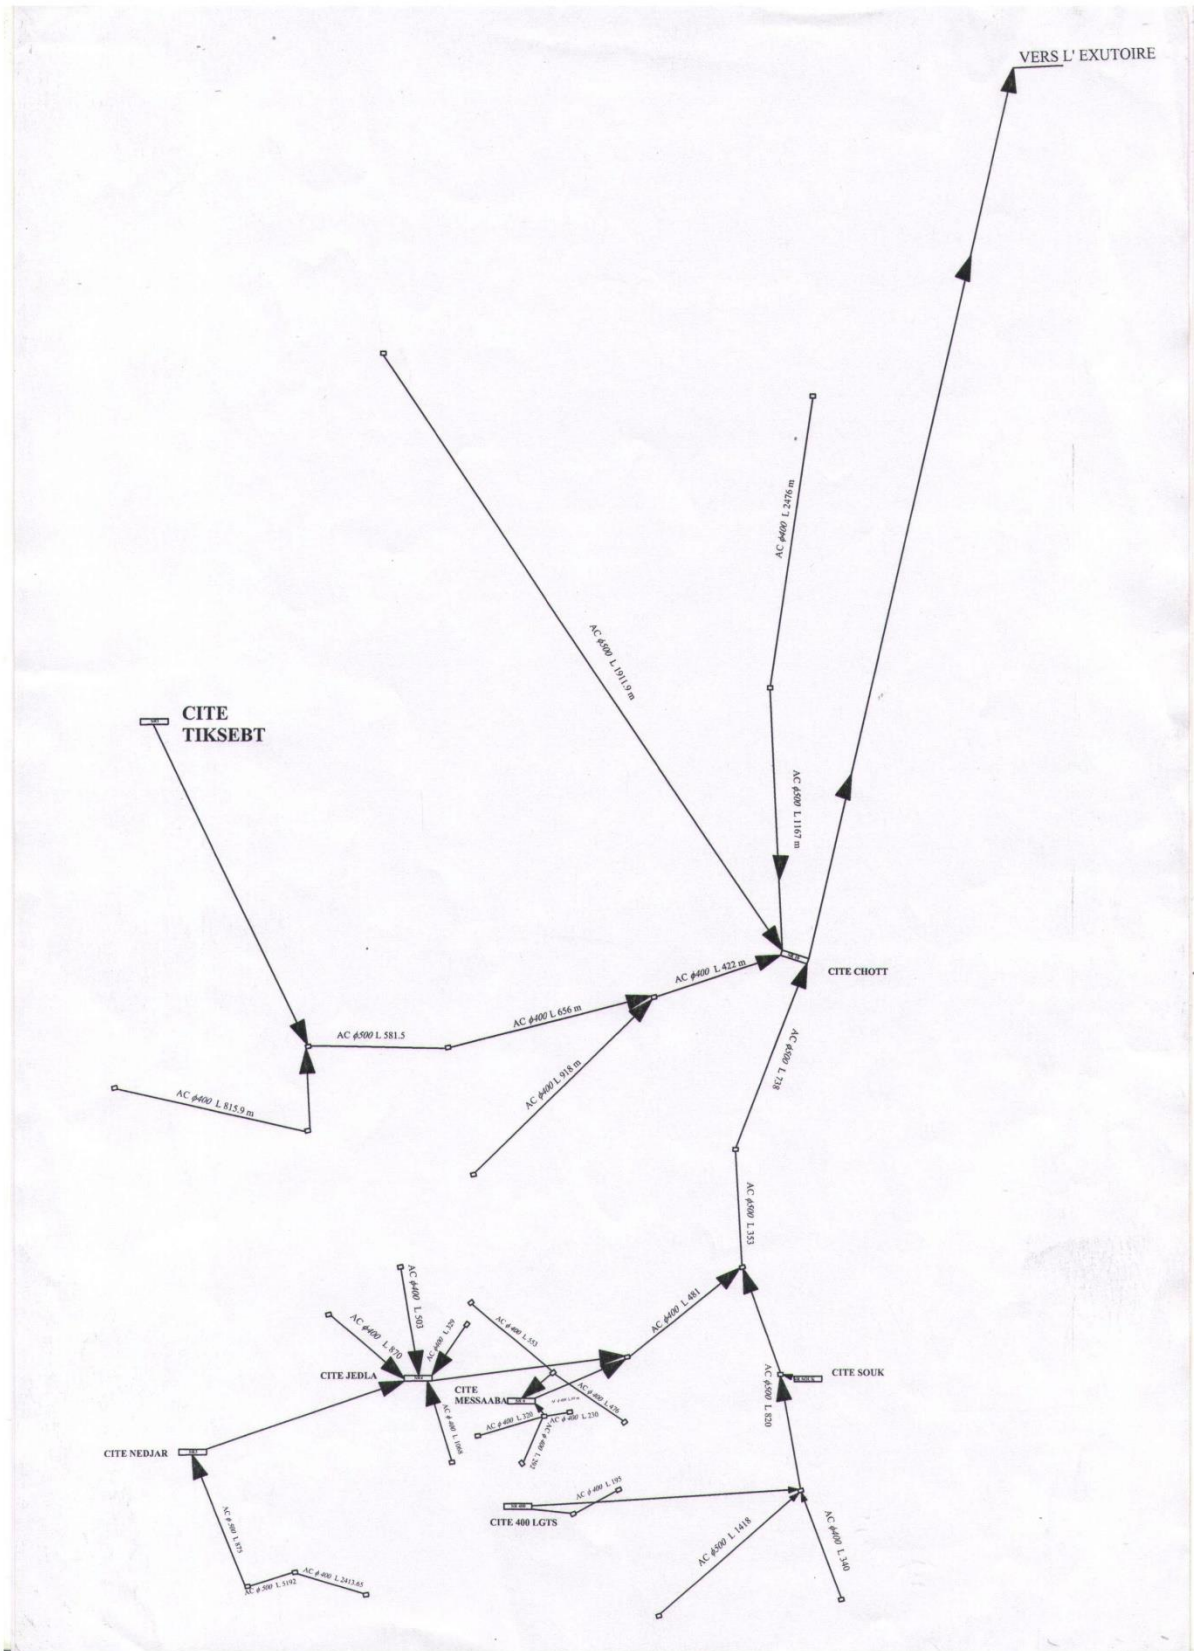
plan de sens écoulement de réseau d'assainissement (DRE)
